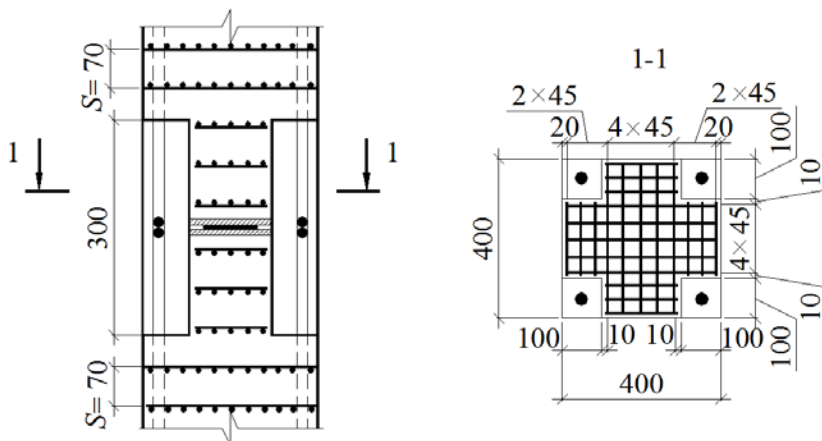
Стык колонн с ванной сваркой выпусков арматуры
